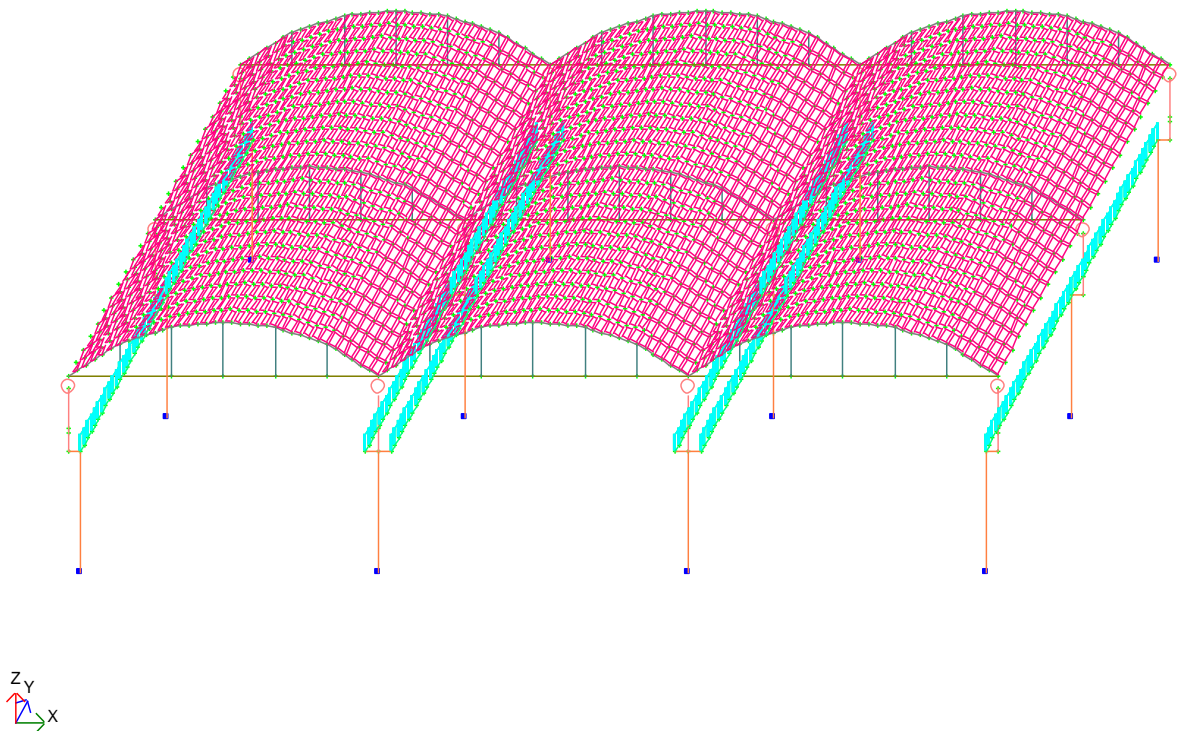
Розрахункова схема рами у просторовому варіанті
